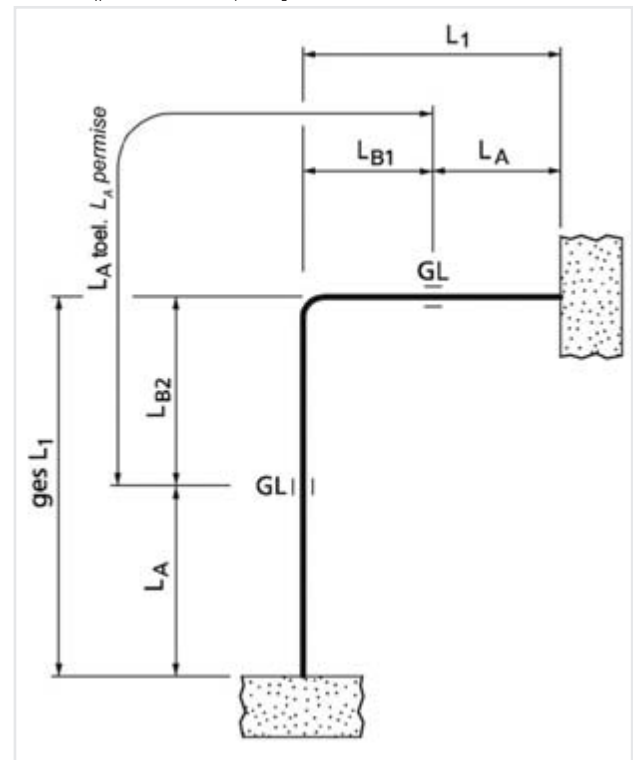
Installation avec bras de flexion et fixation renforcée
